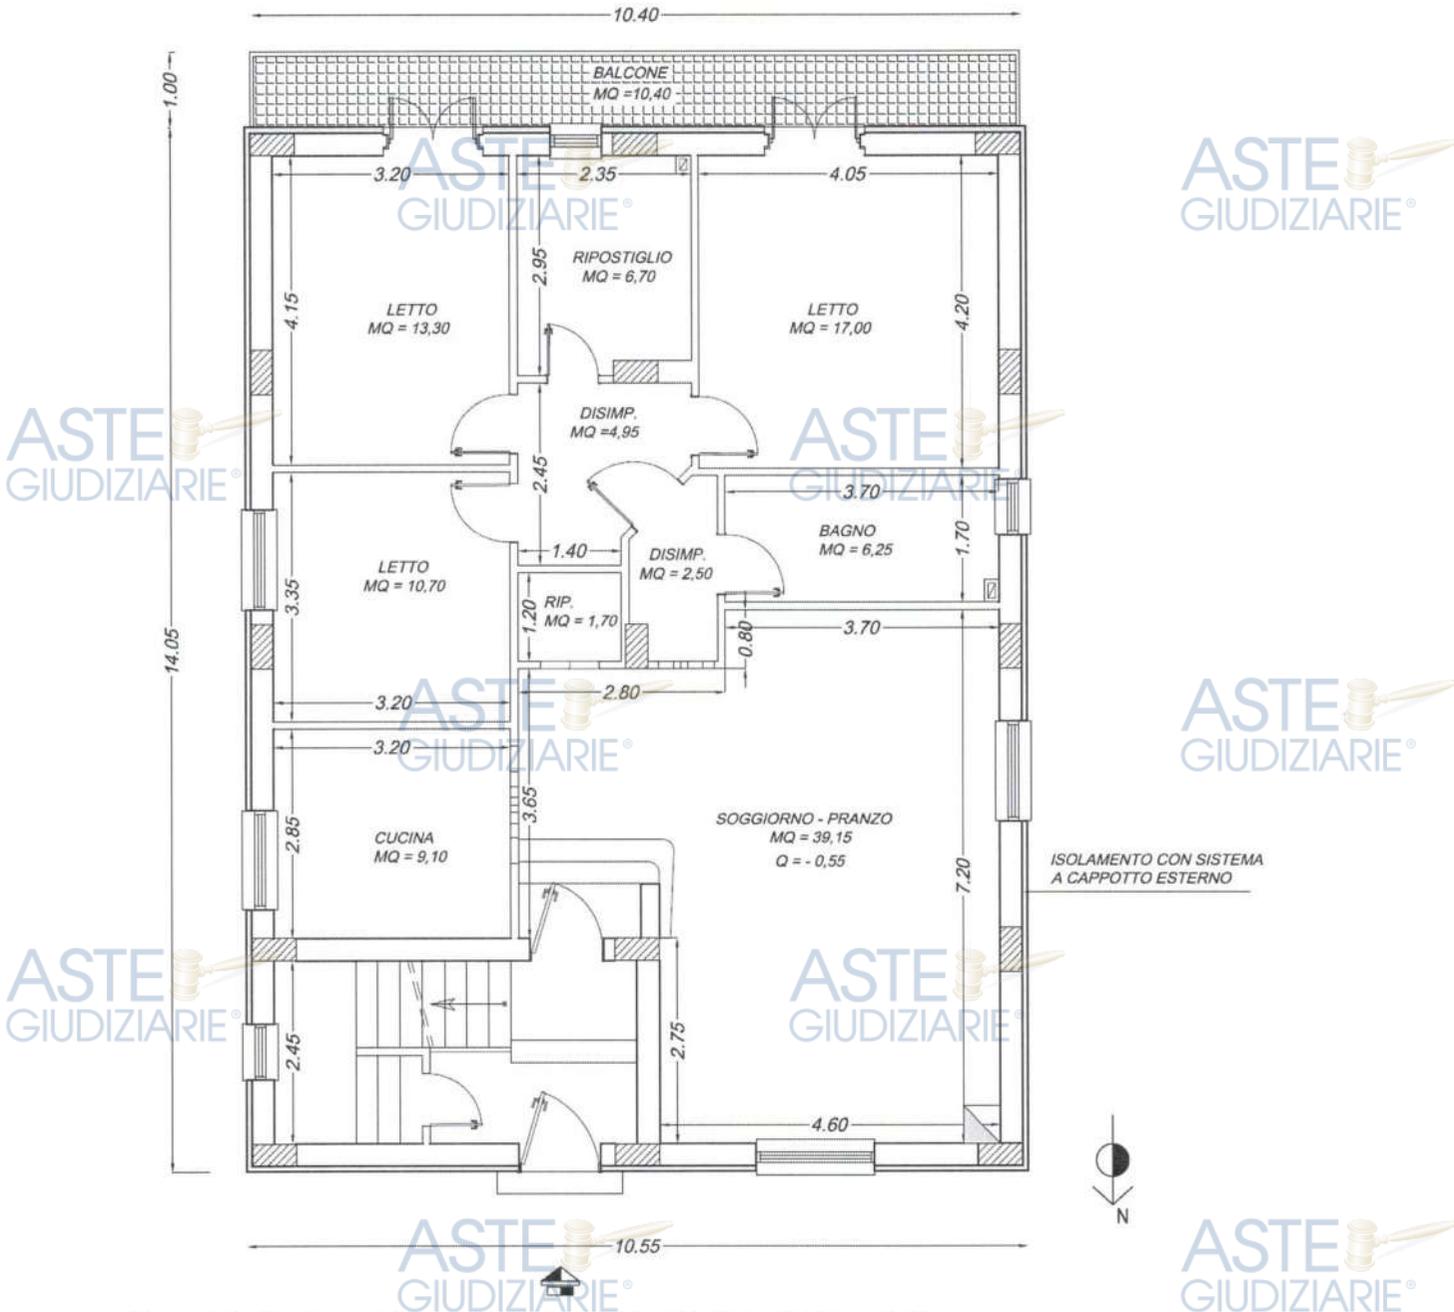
Planimetria Stato di fatto Foglio 23, p.lla 371, sub 7 (ex sub 3)
